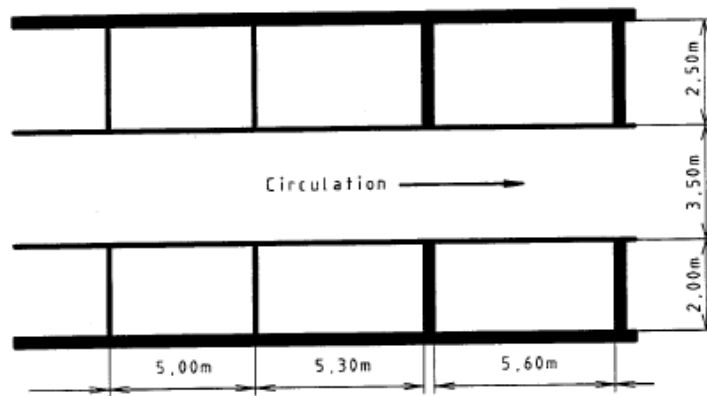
Places de classe A — Application du tableau 2 à un rangement en créneau
